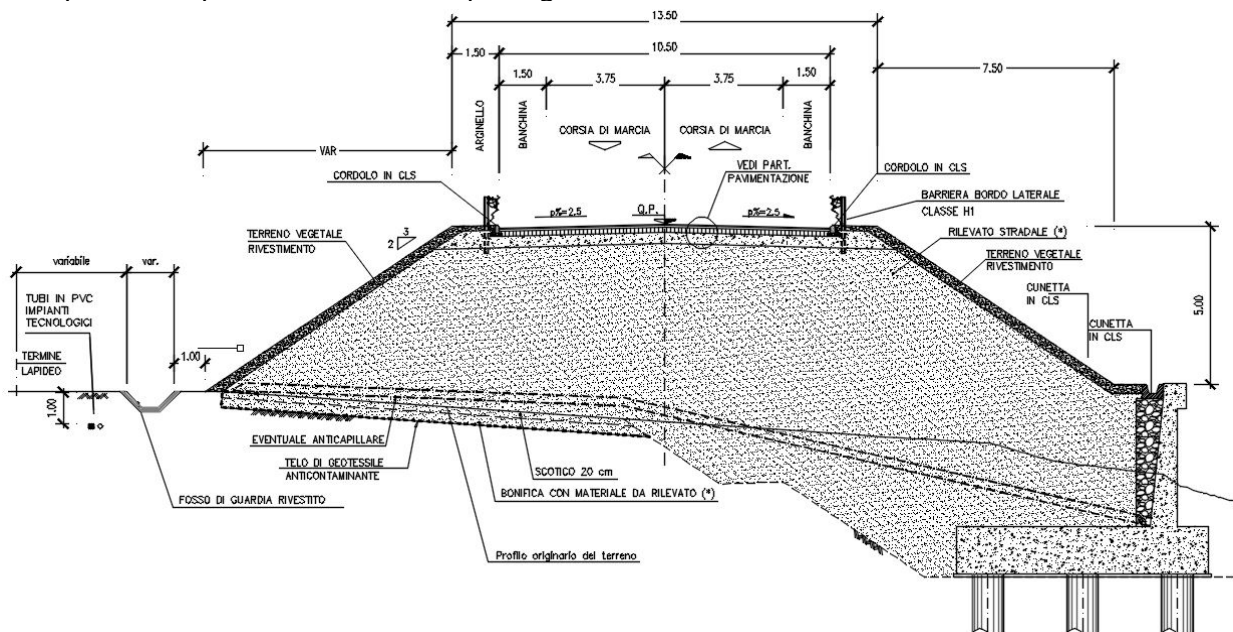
Sezione tipo in rilevato asse principale con muro di sottoscarpa
